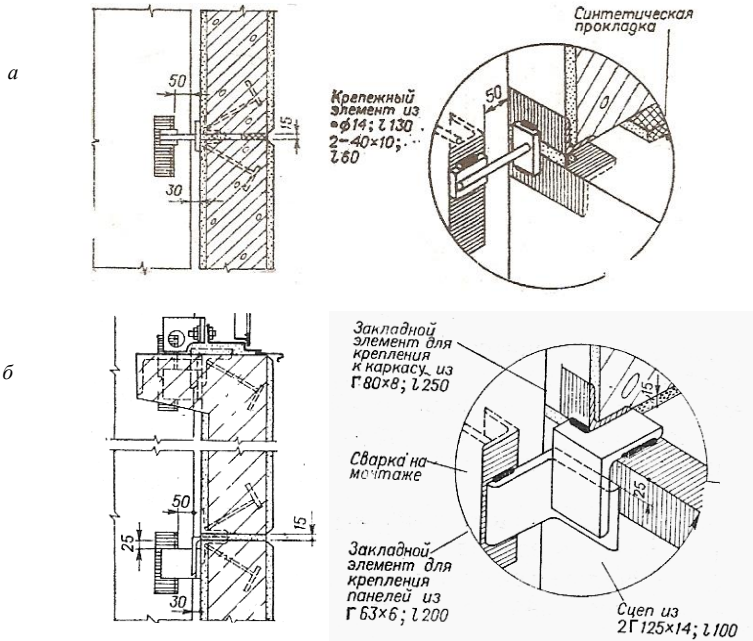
Навеска легкбетонных панелей на колонну: а – при шаге колонн 6 м; б – при шаге колонн 12 м
